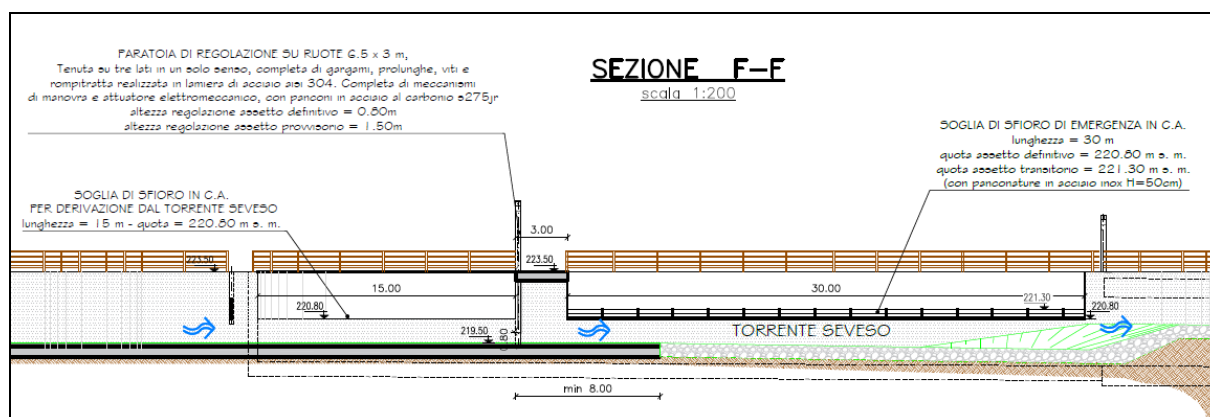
Sezione longitudinale di progetto dell'opera di presa dal T. Seveso
